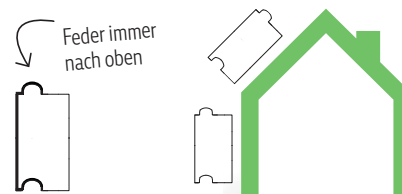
Profilierung ISOLAIR ECO / PAVAWALL LIGHT ab 100 mm
